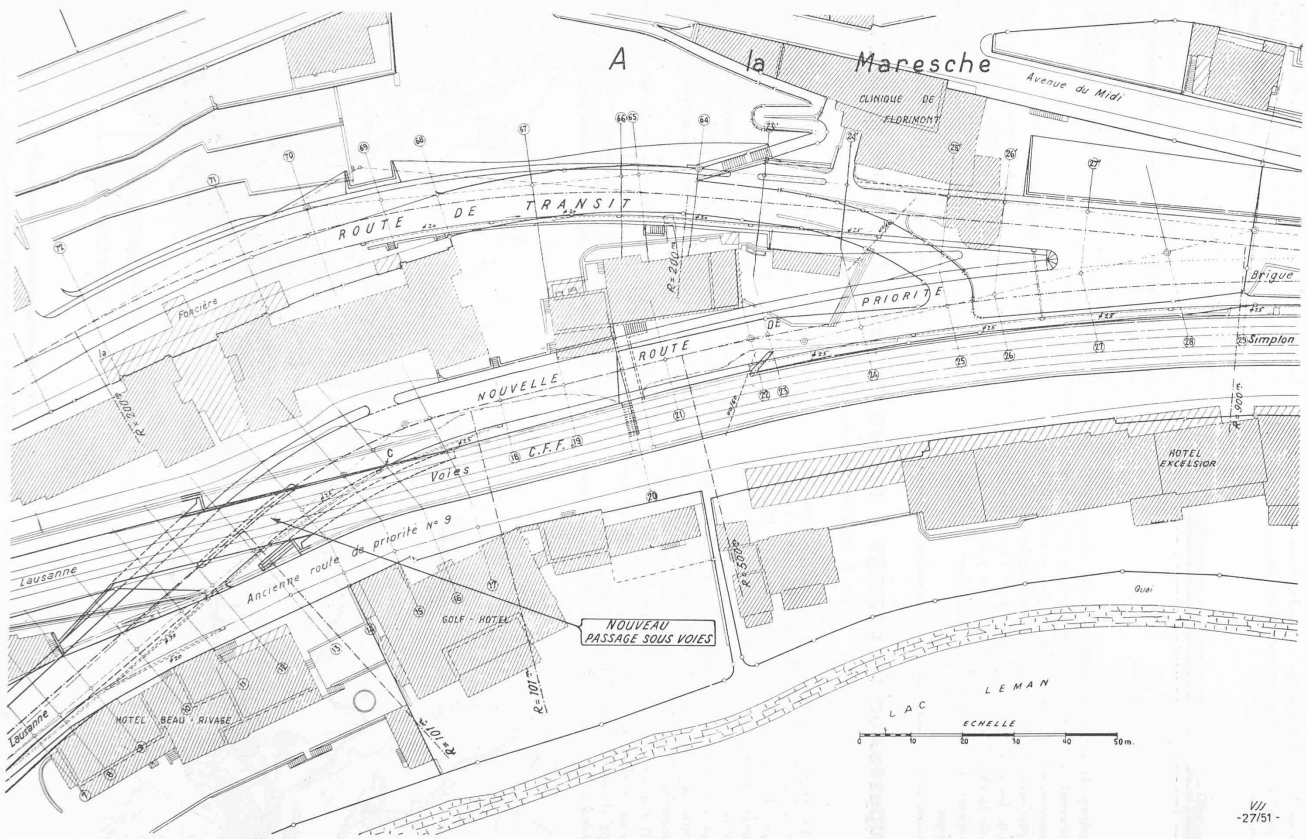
Plan général du projet de route de transit et du nouveau passage sous voies.
